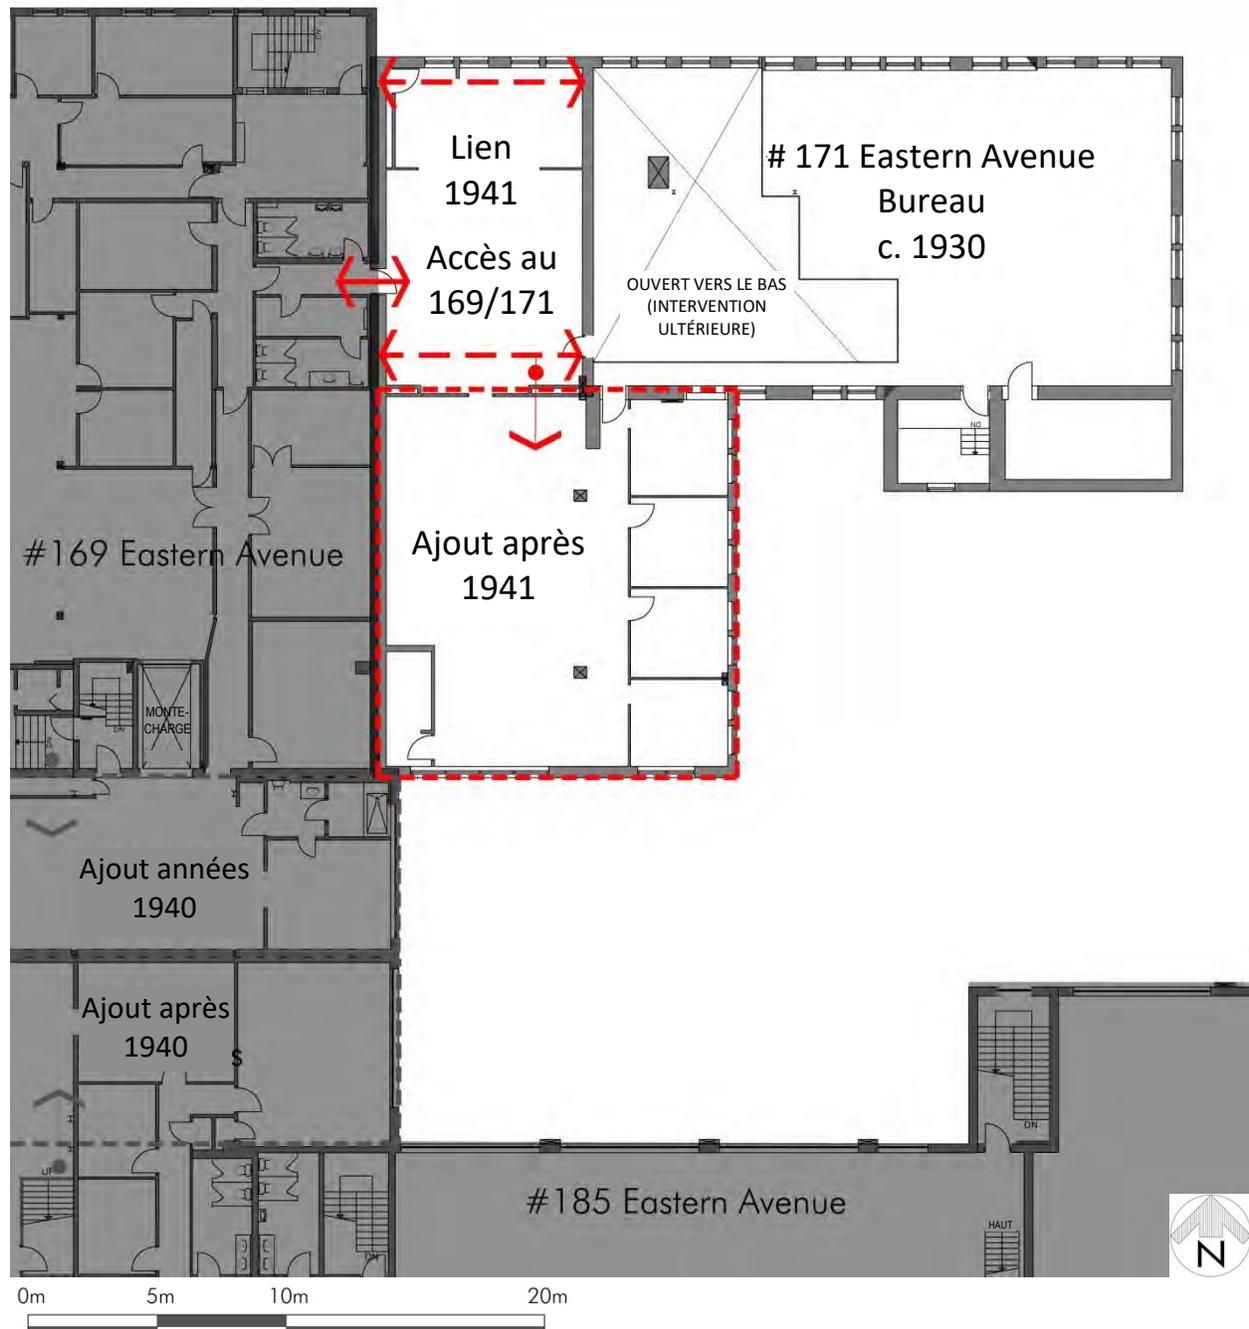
7 avenue Eastern – Plan du deuxième étage des bureaux.
